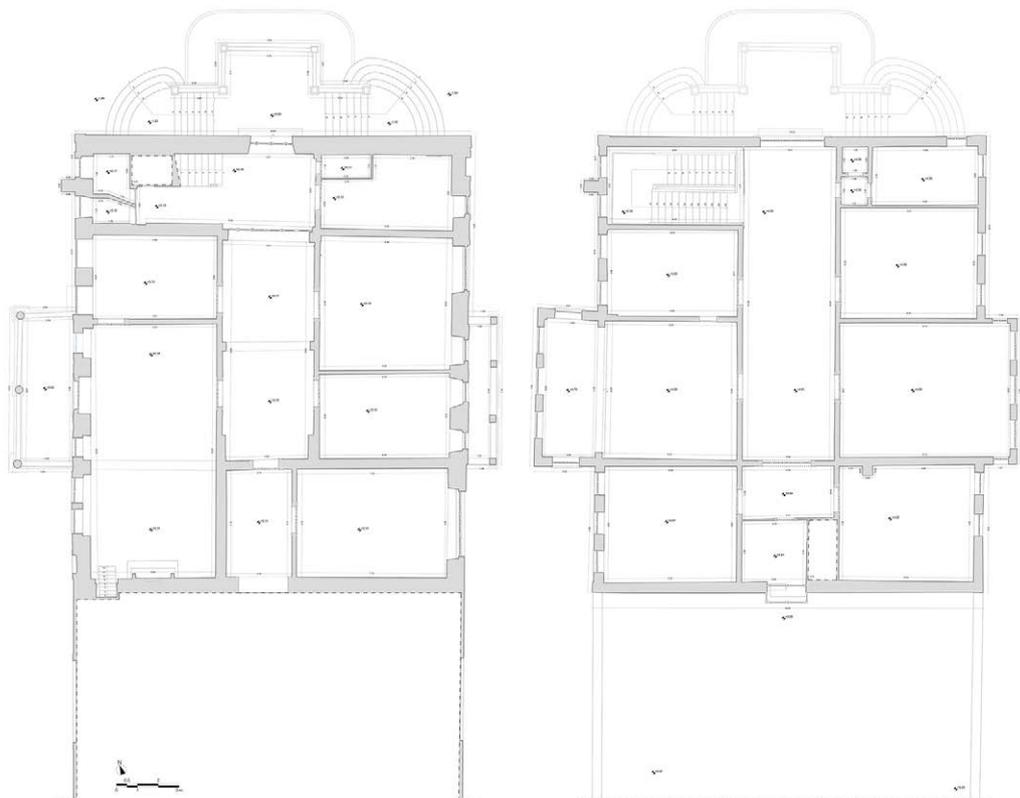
Pianta del piano terra e del piano primo dell'Akademia e Shkencave Tiranë. Elaborazione di CHM\_lab.
